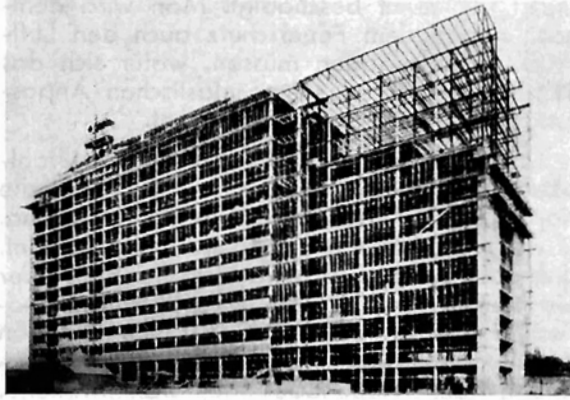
Bundesstatistisches Zentralamt in Wiesbaden
